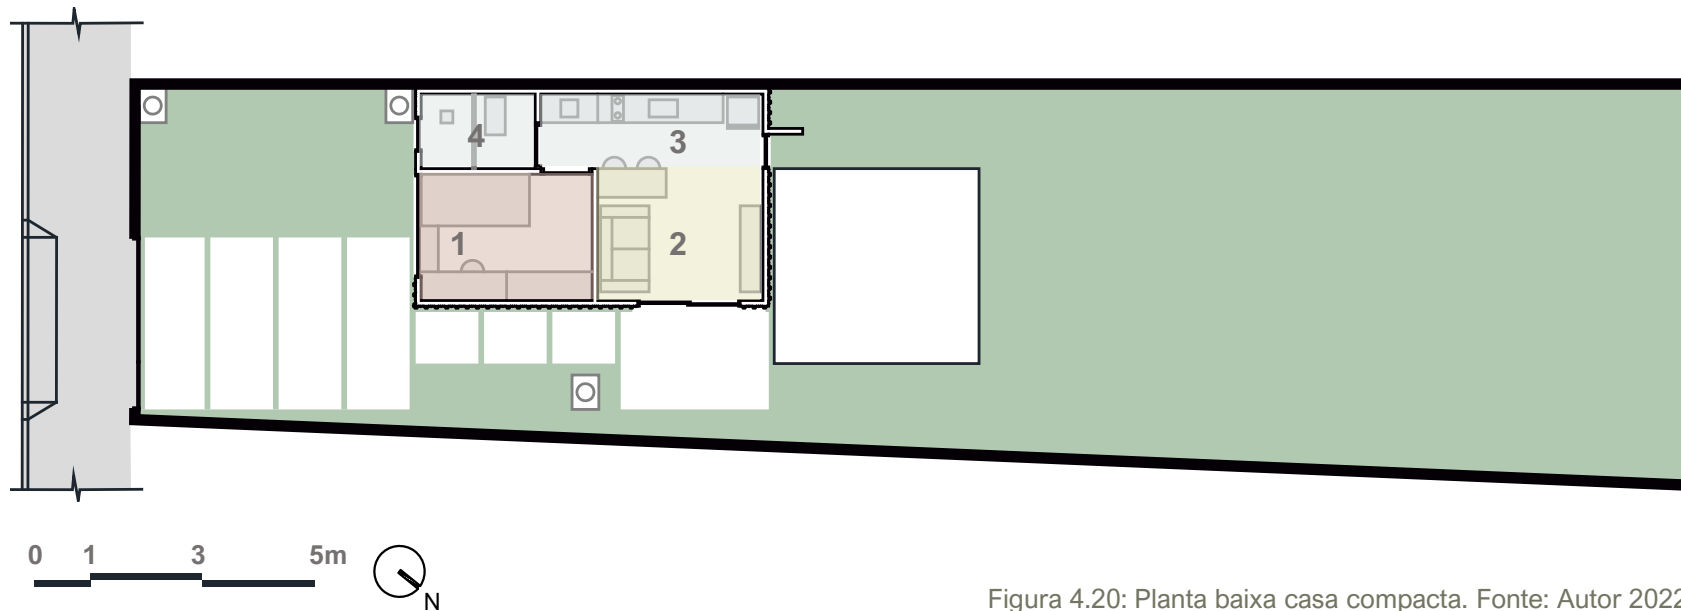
Planta baixa casa compacta. Fonte: Autor 2022.
